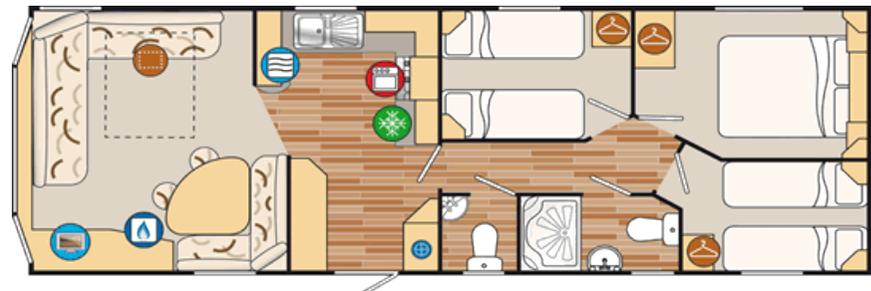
, Grundriss eines Wohnwagens[54]
